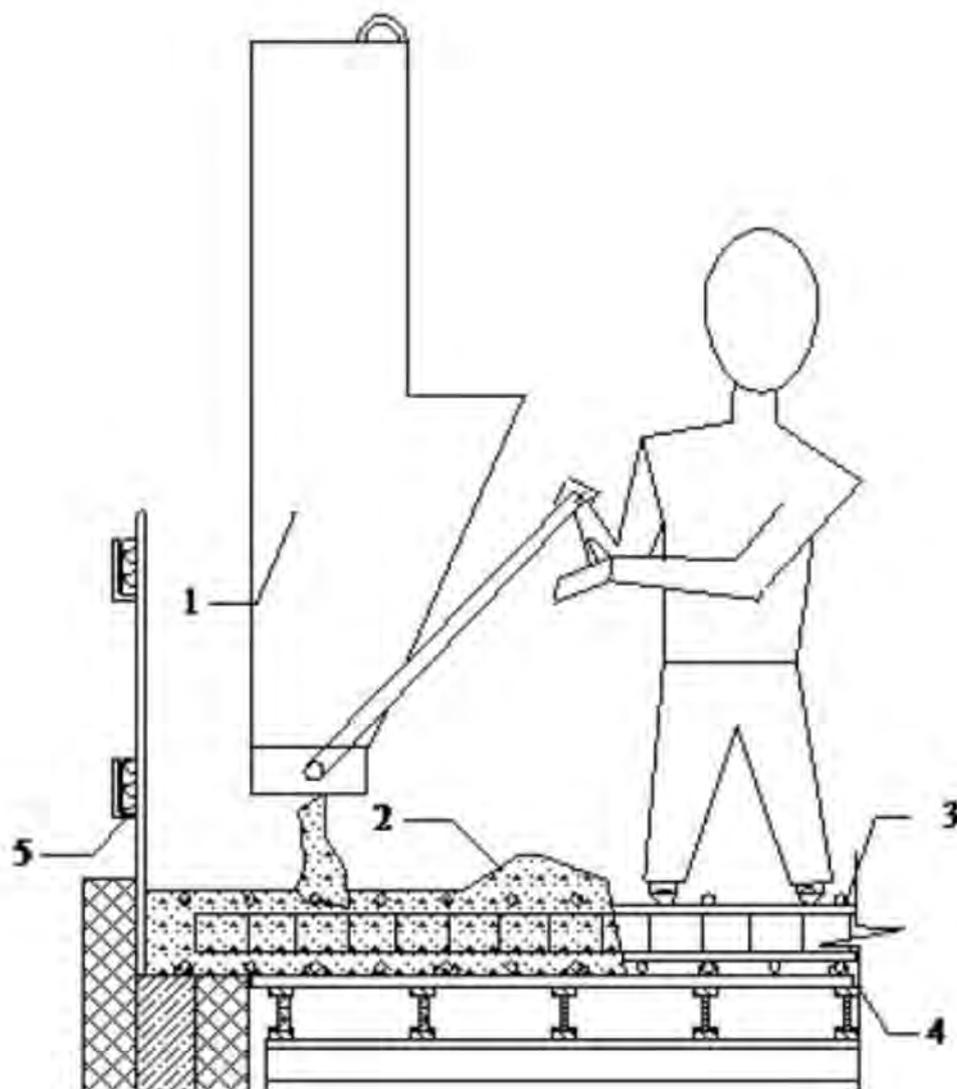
Укладка бетонной смеси: 1-бункер для подачи бетона, 2-укладываемый бетон, 3-арматурная сетка, 4-конструкция опалубки перекрытия, 5-инвентарное ограждение.
